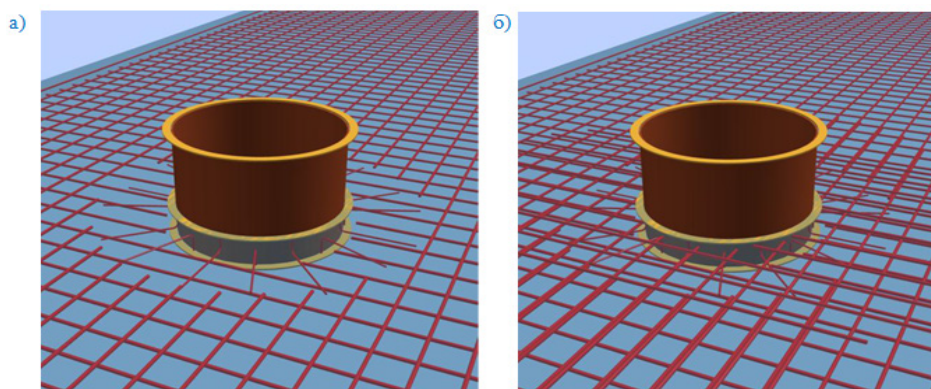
Узел установки закладного изделия (трубной проходки) в армоконструкцию плиты перекрытия: а) вид без дополнительной арматуры; б) вид с установленной дополнительной арматурой
